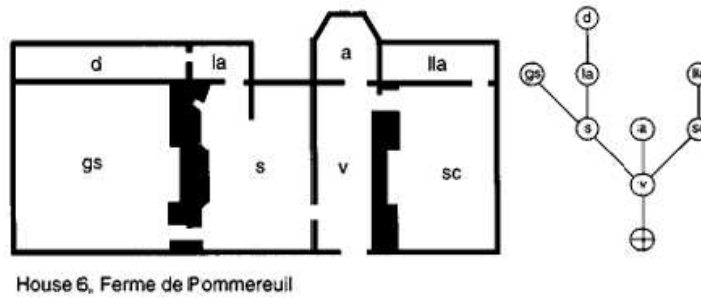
Planta baixa e grafo justificado - House 6, Ferme de Pommereuil.
